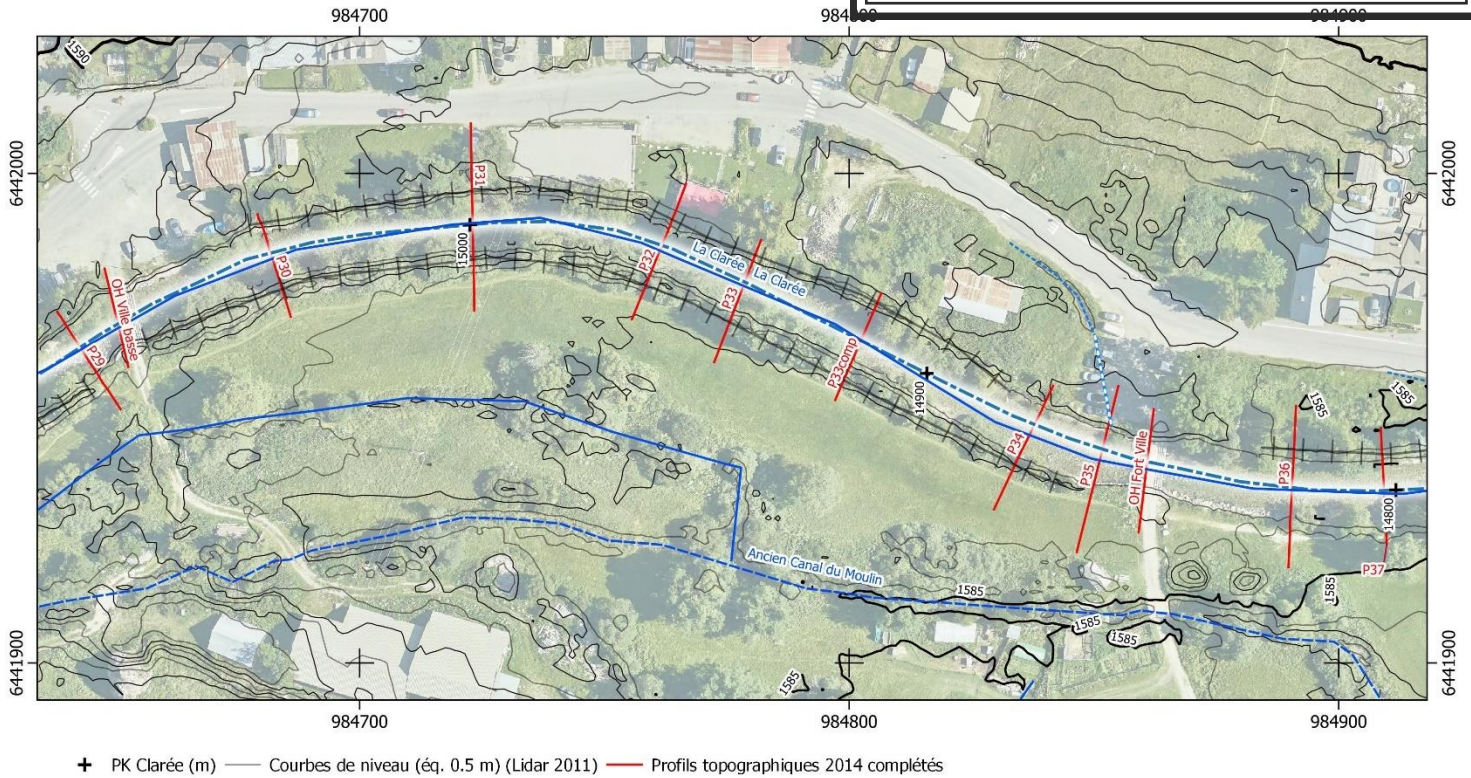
Merlon rive droite à Ville Basse - Topographie du site et situation des profils en travers
